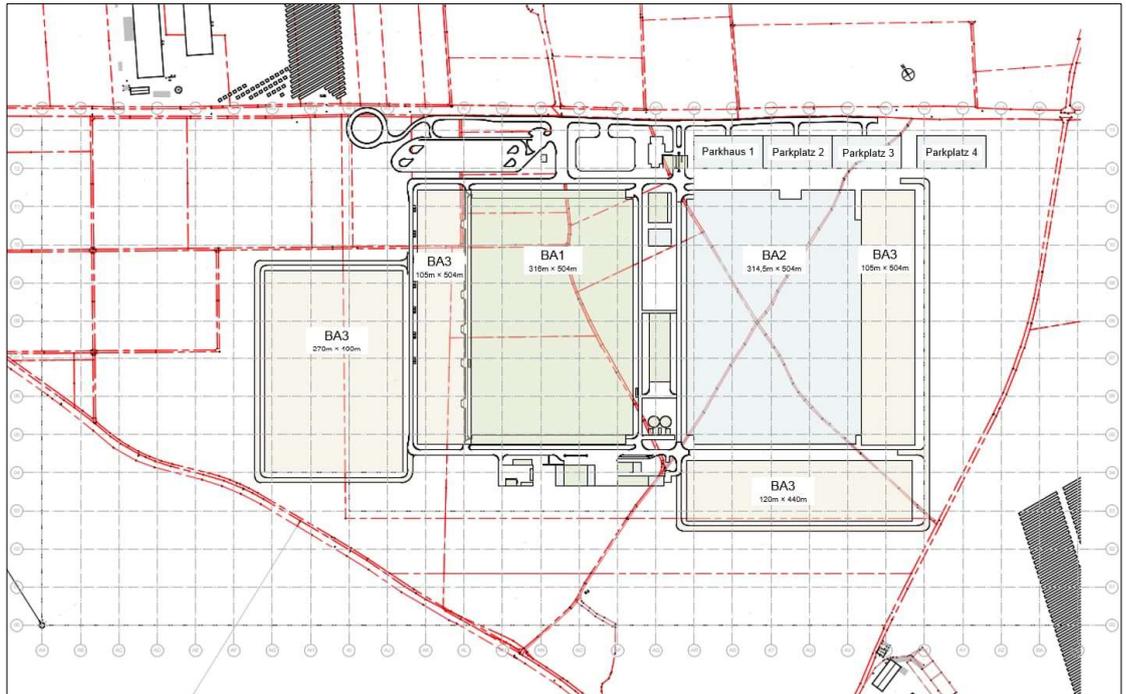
Planfall 2 mit Gebäuden (BA1 hellgrün, BA2 hellblau, BA3 gelb).
